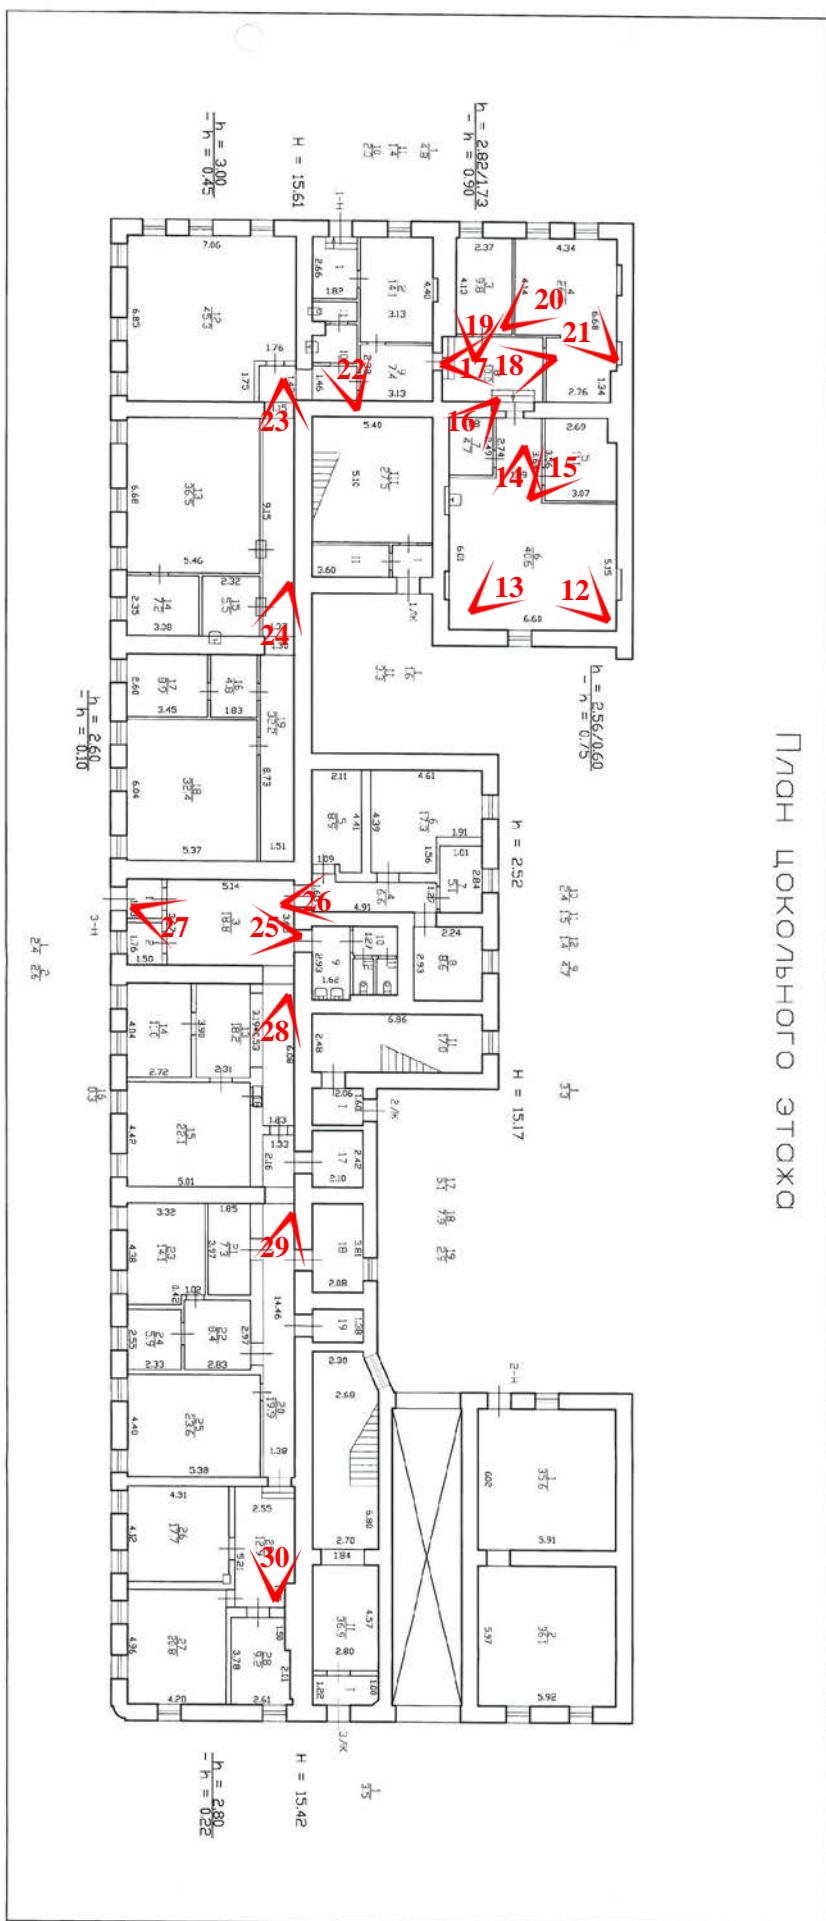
Схема фотофиксации на плане цокольного этажа
